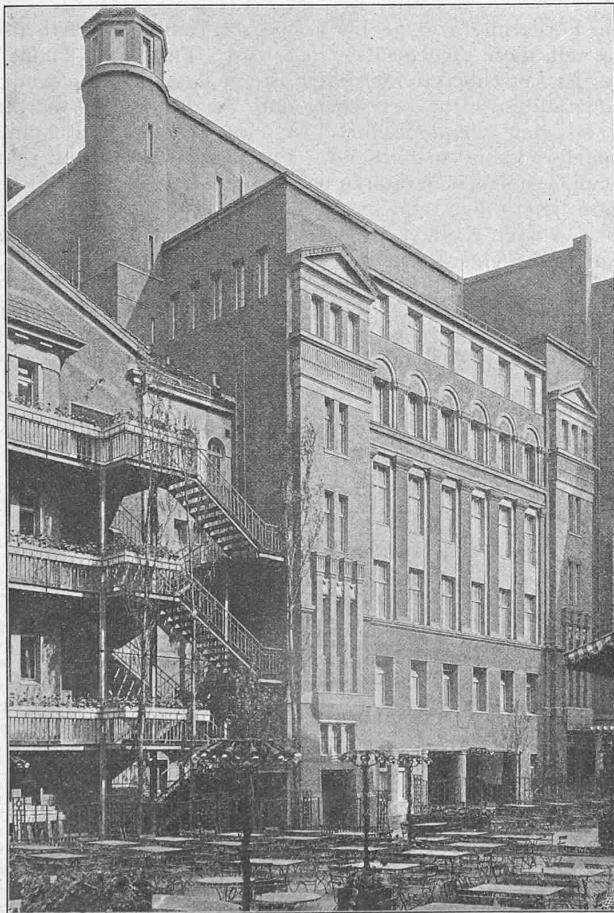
Hofansicht des Bühnenhauses mit den Nottreppen. Konzertgarten.
